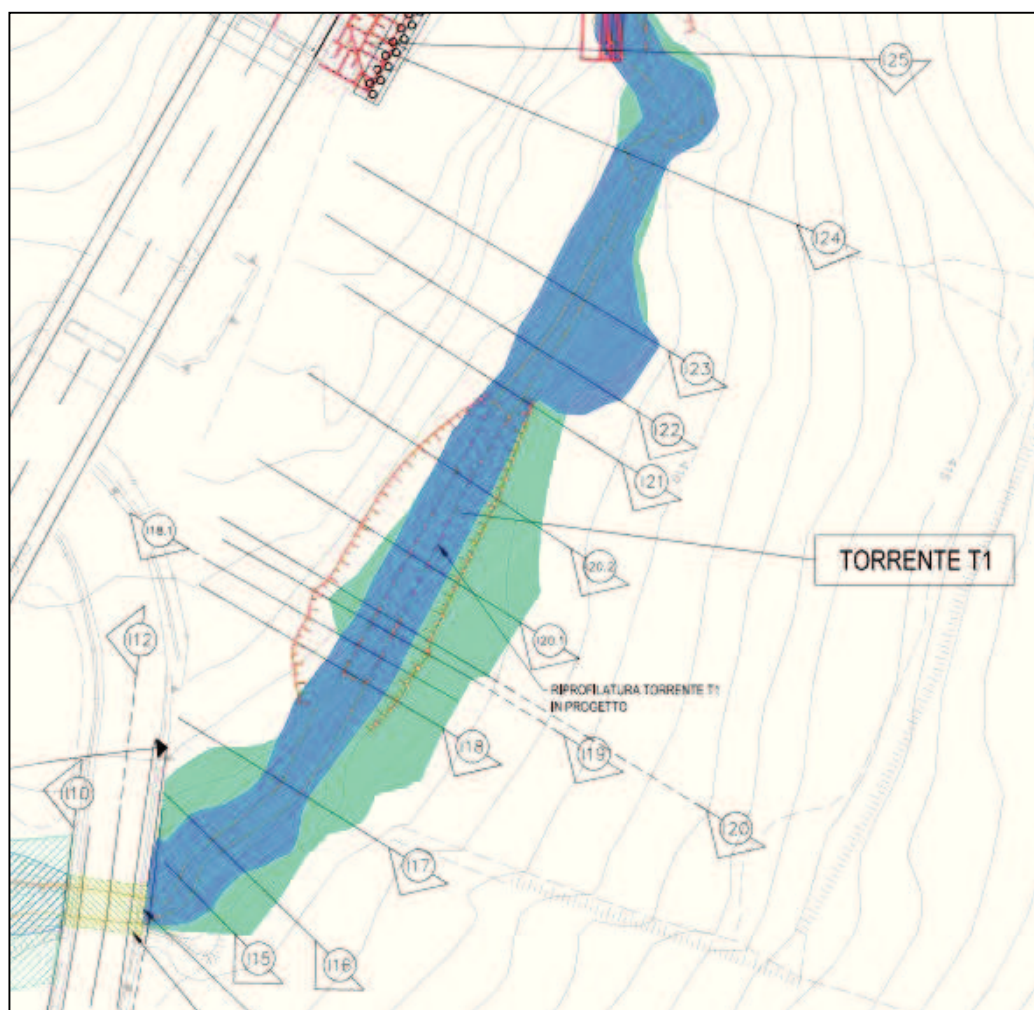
Stralcio planimetria aree esondabili torrente T1 in condizioni di stato di fatto e di progetto TR 100 anni – tratto in corrispondenza dei tombini esistenti.
